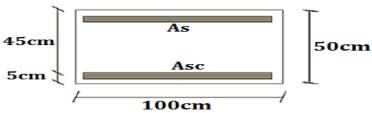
Dimensions de la section transversale de la dalle du radier
